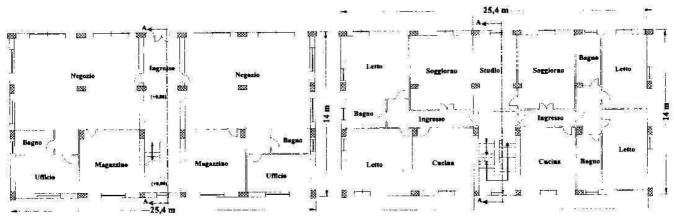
Pianta piano tipo (sx) e primo piano (dx)
